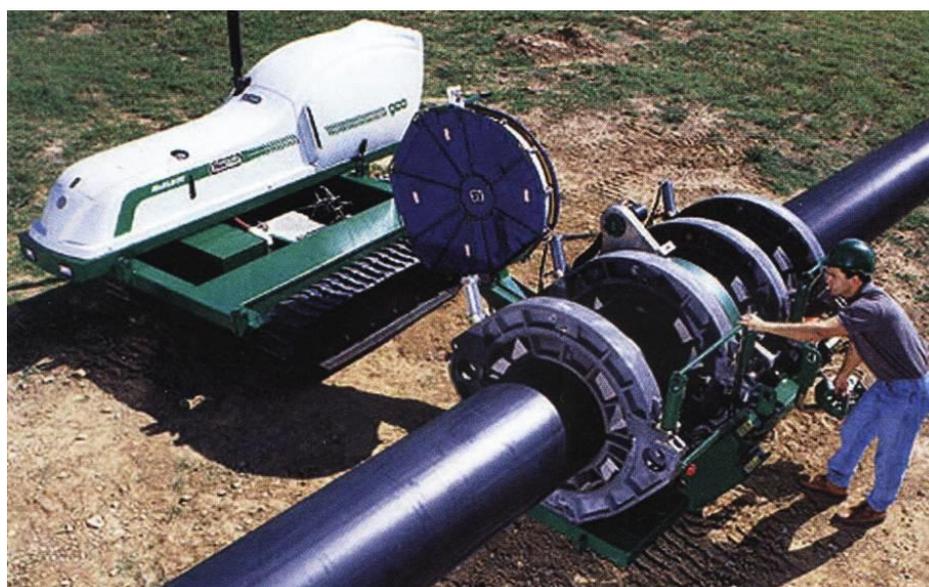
Фрагмент подготовки полимерных труб для сварки
